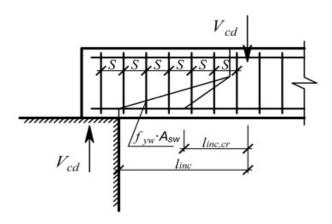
Схема усилий в сечении, наклонном к продольной оси железобетонного элемента, при расчете его на прочность на действие поперечной силы
